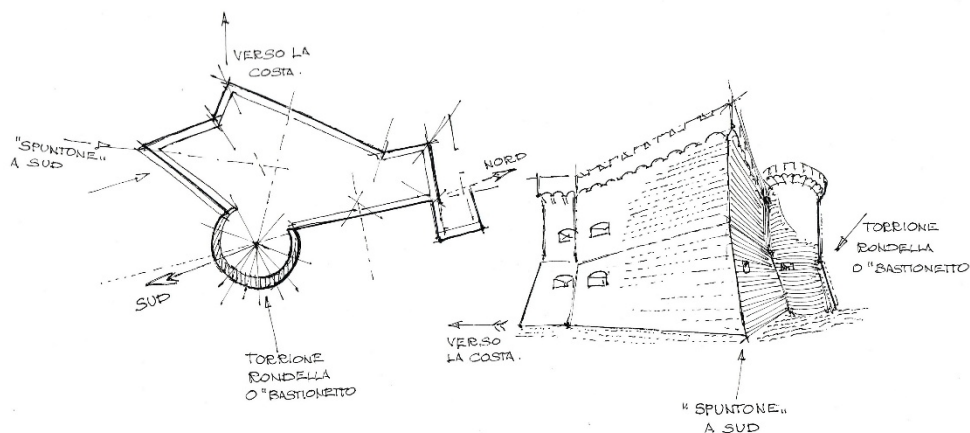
Il Castello di Levanto, planimetria e vista prospettica (elaborazione grafica di Francesco Broglia, 2024).
